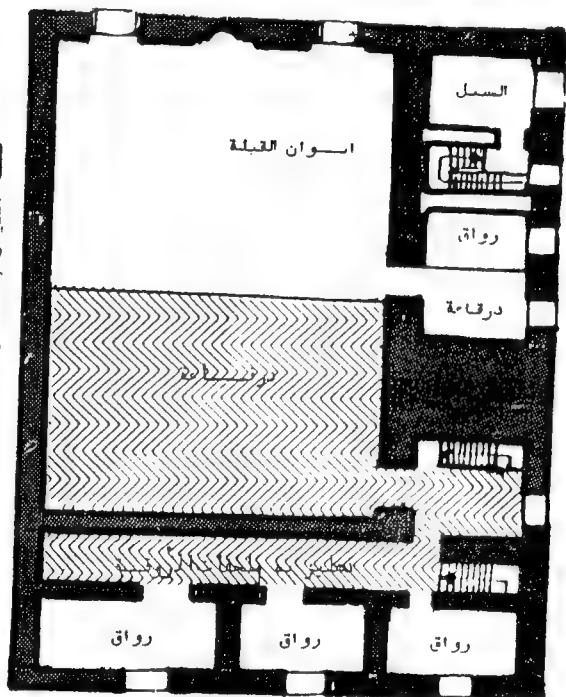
مسقط الخي (تخلي) للدور الأرضي سفلى المسجد
